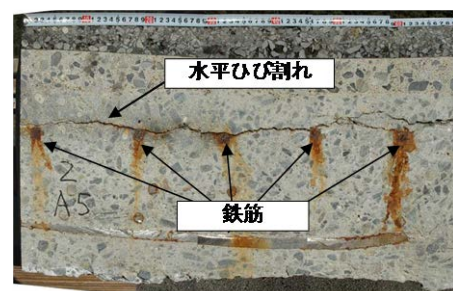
RC床版内部の鉄筋位置での水平ひび割れの発生状況
